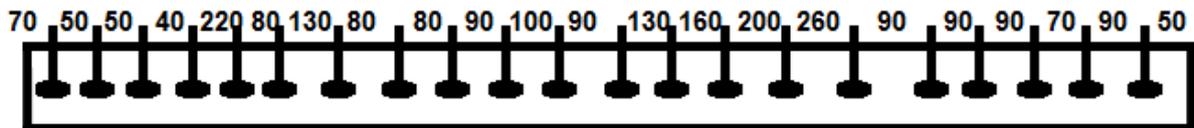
Perfil “U” inferior – Vista superior – fixação na alvenaria
